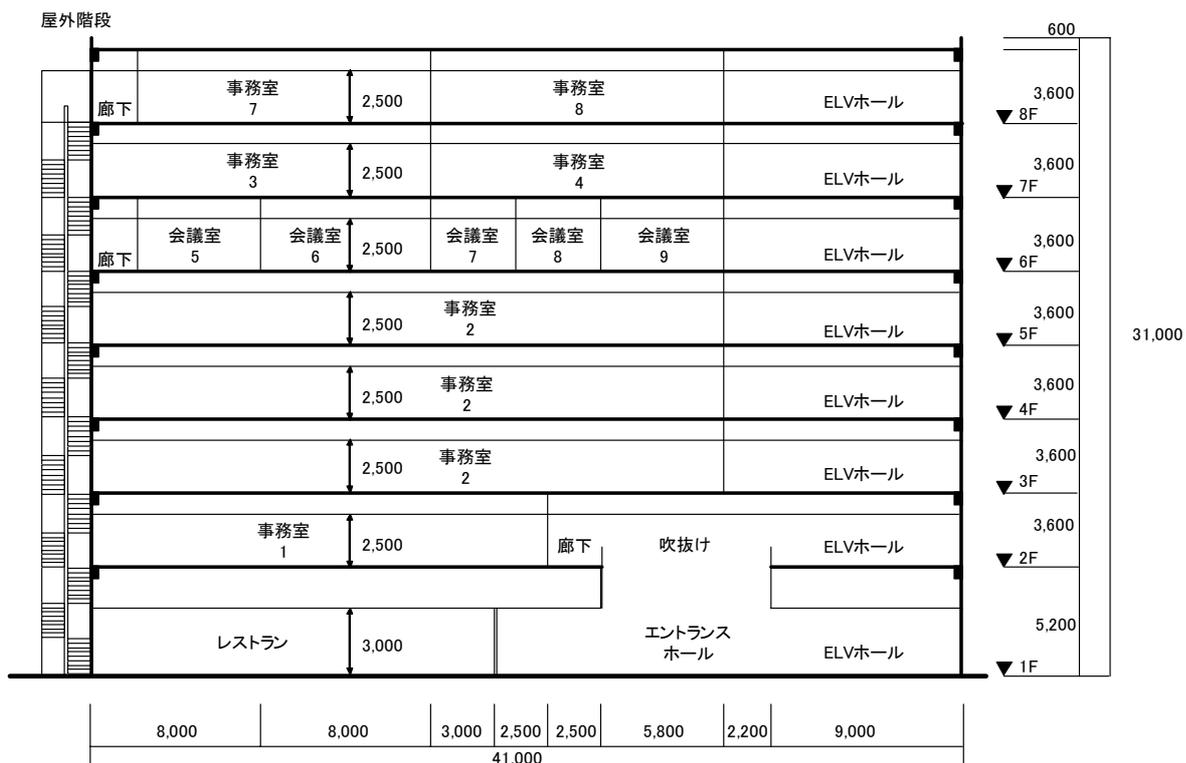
断面図 ((b)-(b)断面 (図 3.2-3 参照))
